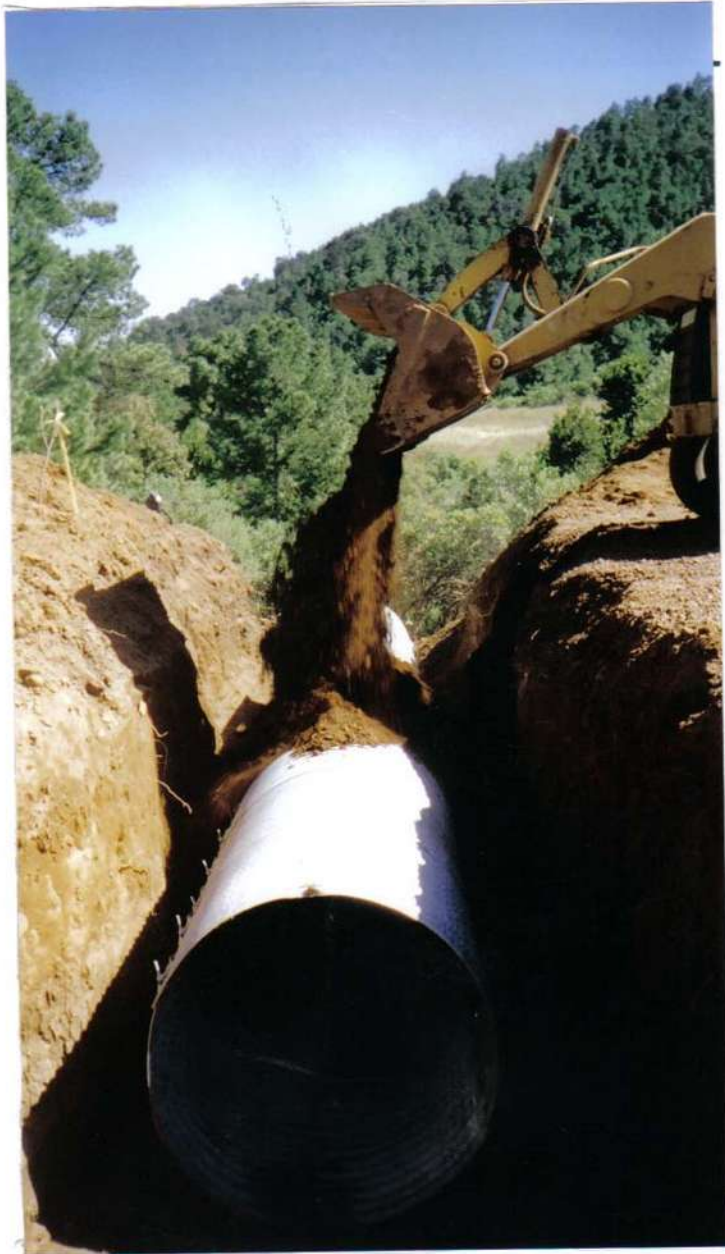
Colocación de tubería de metálica como alcantarilla.
